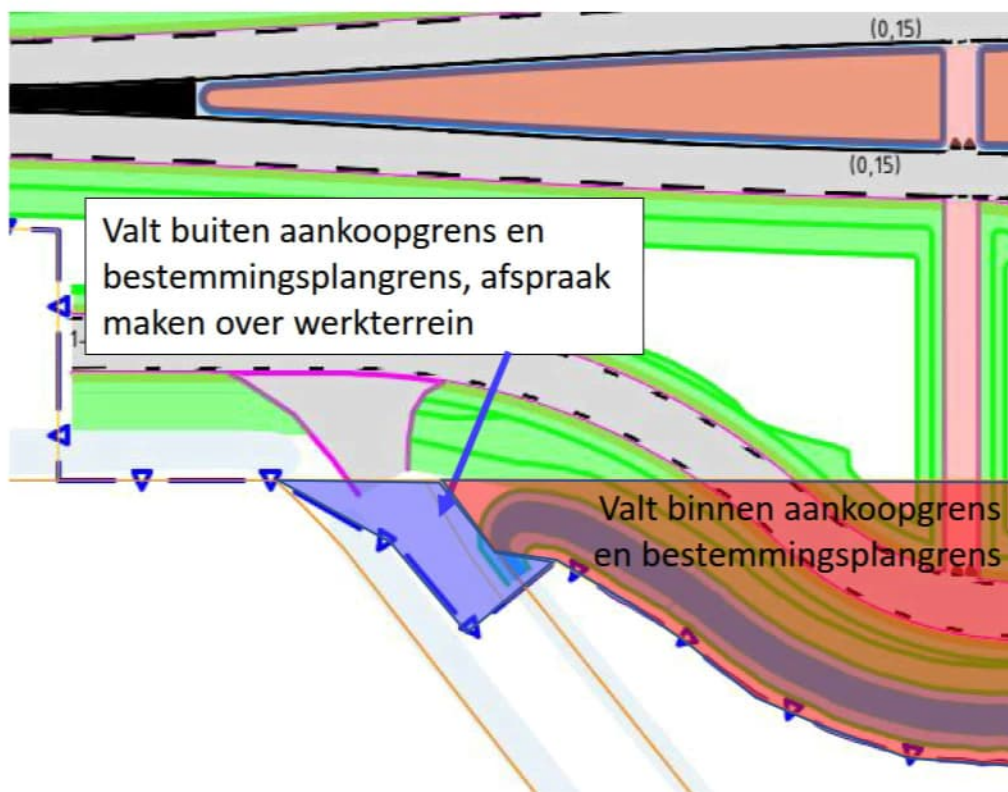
Verbeelding ontwerp met plangrens en aangepaste bestemmingsplan- en aankoopgrens
